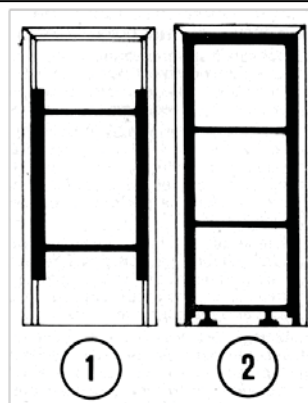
MARCOS METÁLICOS DE PUERTA RIGIDIZADOS con escantillones para evitar su deformación durante el colado de muros de concreto o durante la fijación de sus anclas sobre muros de mampostería con mortero.
